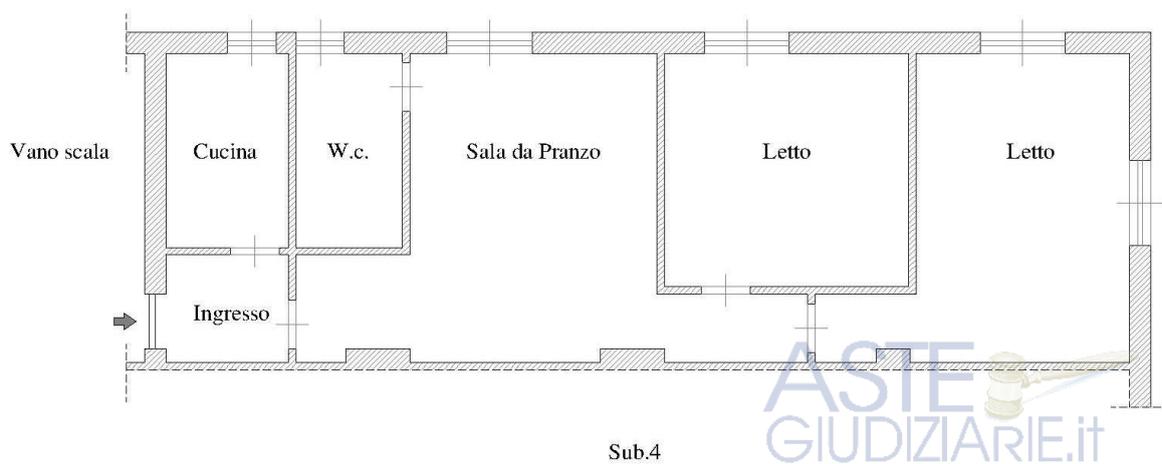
Planimetria Abitazione (n.2) piano secondo
